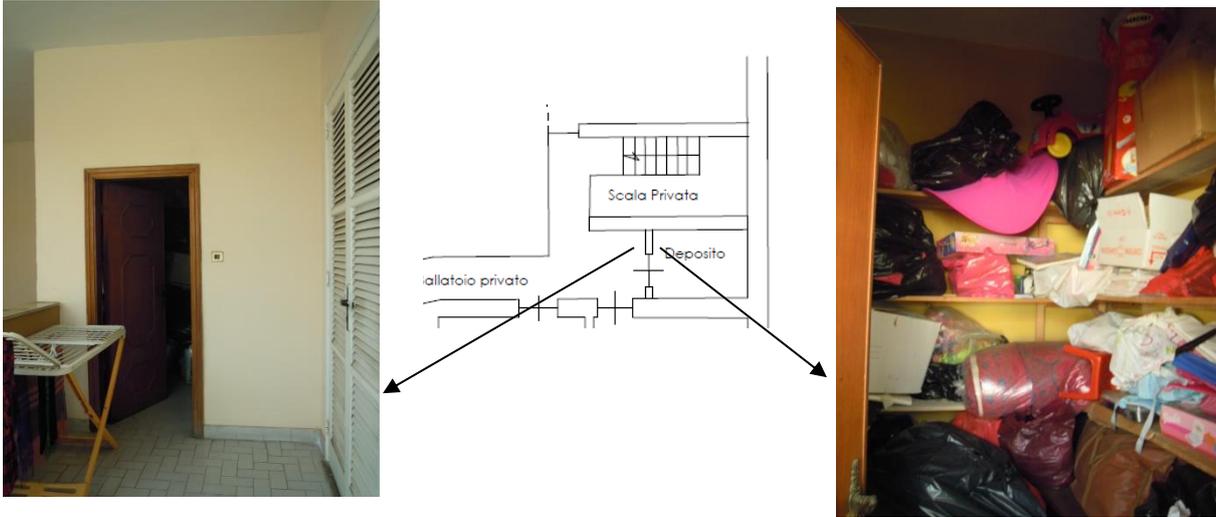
Individuazione fotografica del deposito del bene oggetto di pignoramento.
